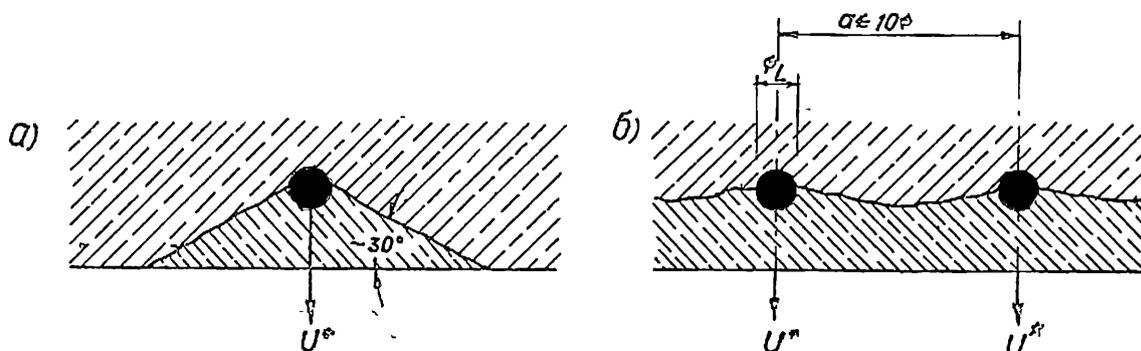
4 Схемы разрушения защитного слоя бетона при действии нагрузки в результате усилий отрыва, создаваемых изогнутыми стержнями
